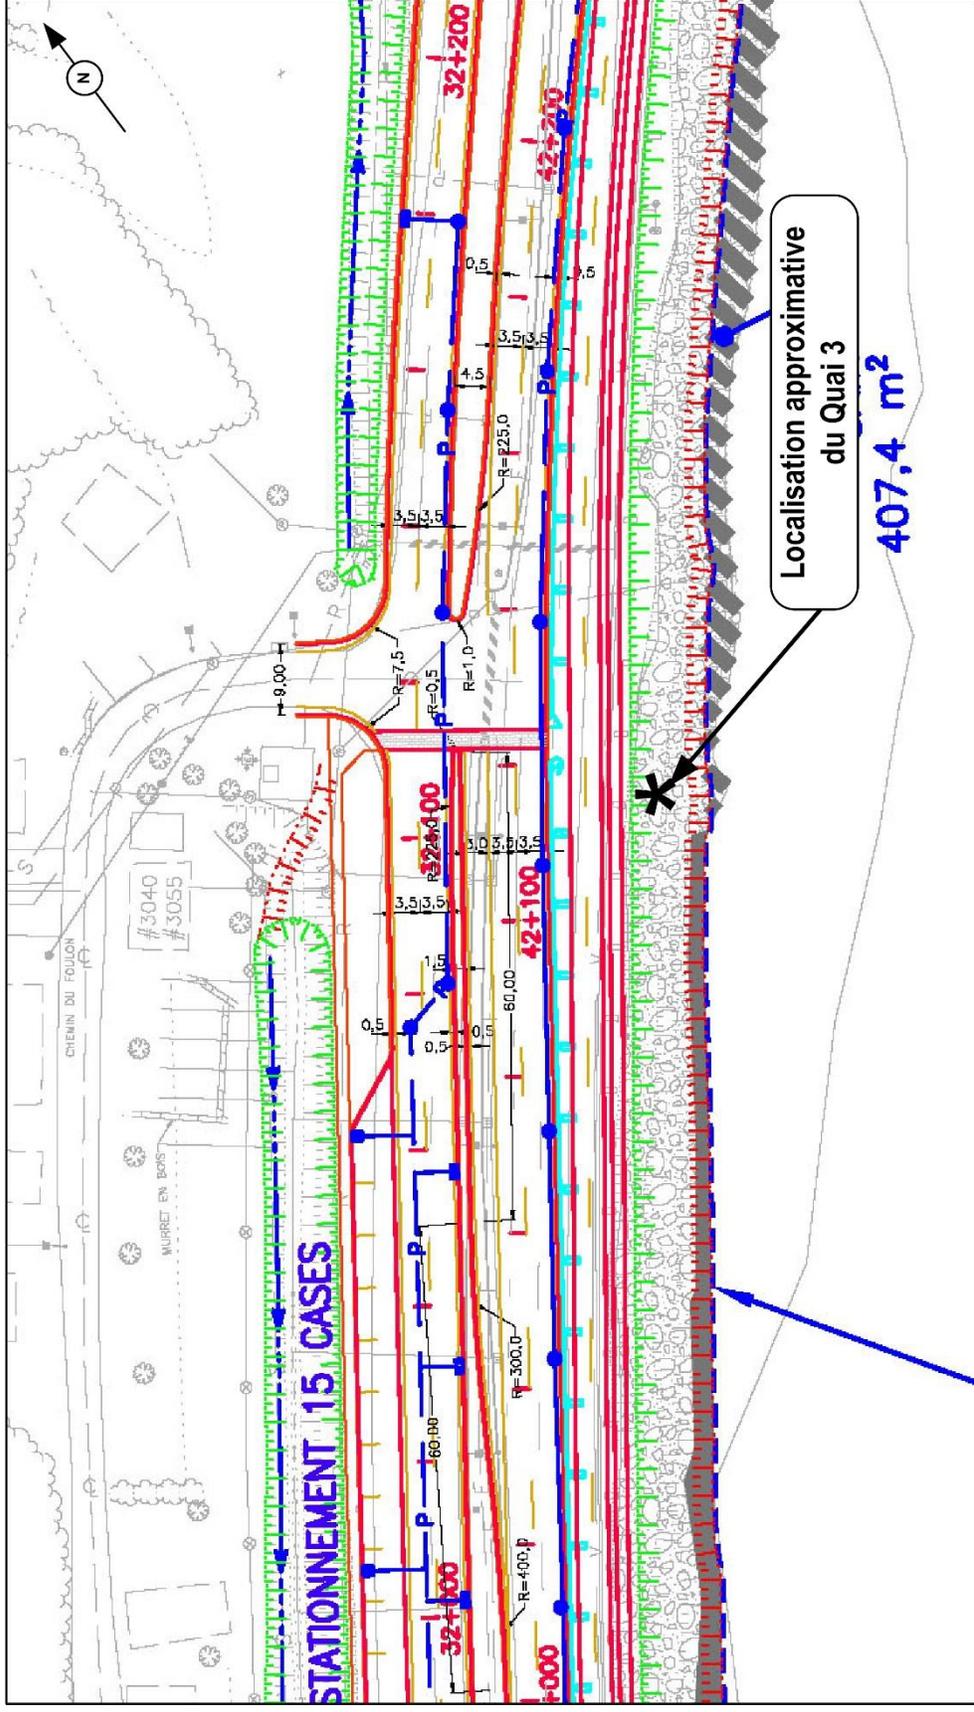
Localisation approximative du quai 3 sur le plan de construction (extrait du plan MTQ Ch-154-07-1475 Boulevard Champlain, vue en plan et profils [variante 7])
